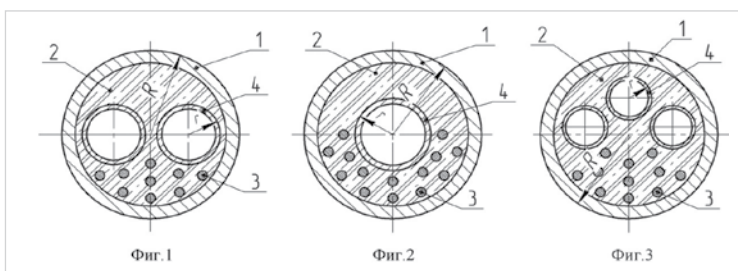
Сечение трубобетонной балки с предварительно напряженной арматурой
